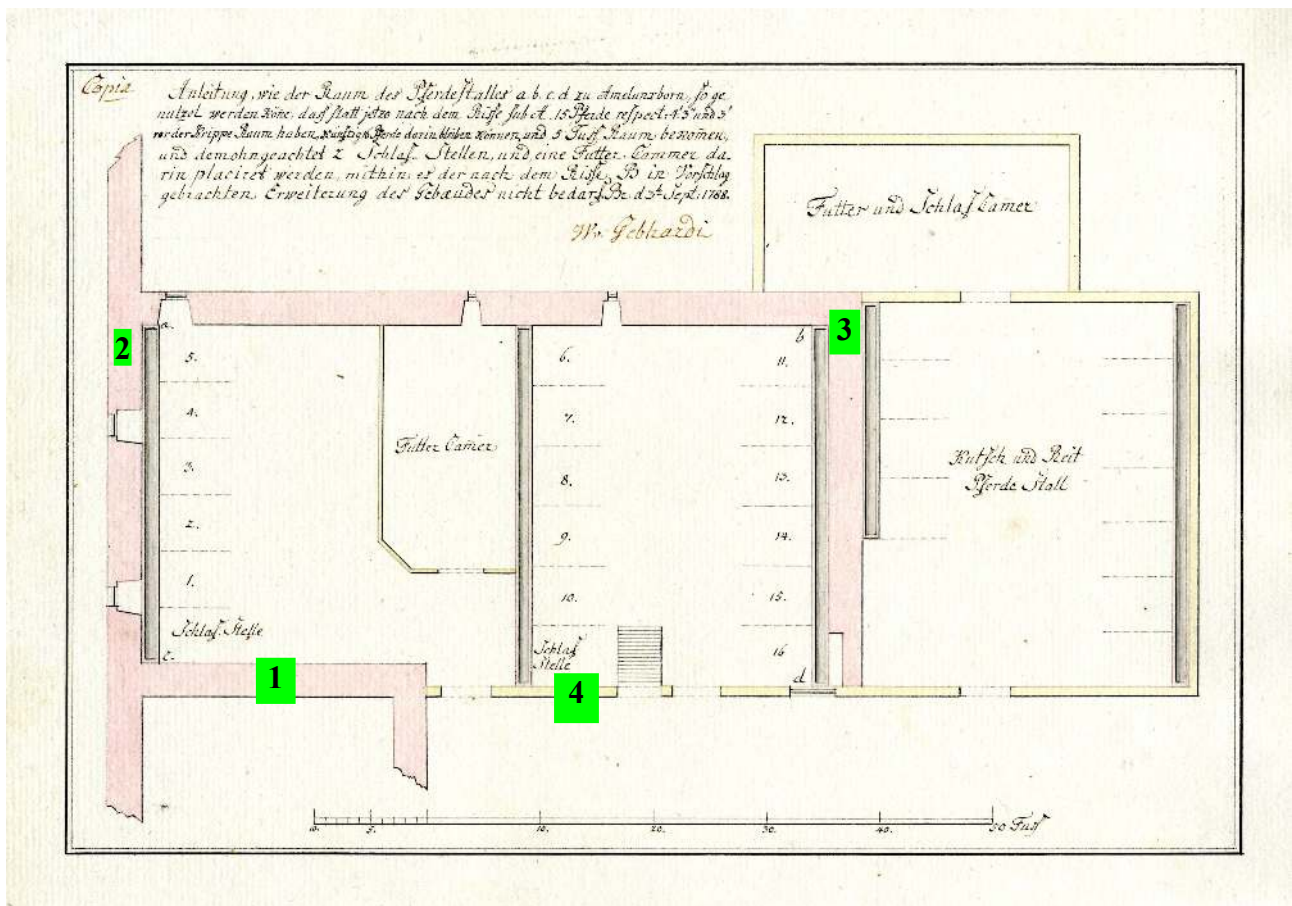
Grundriss des Pferdeftalles von 1788
